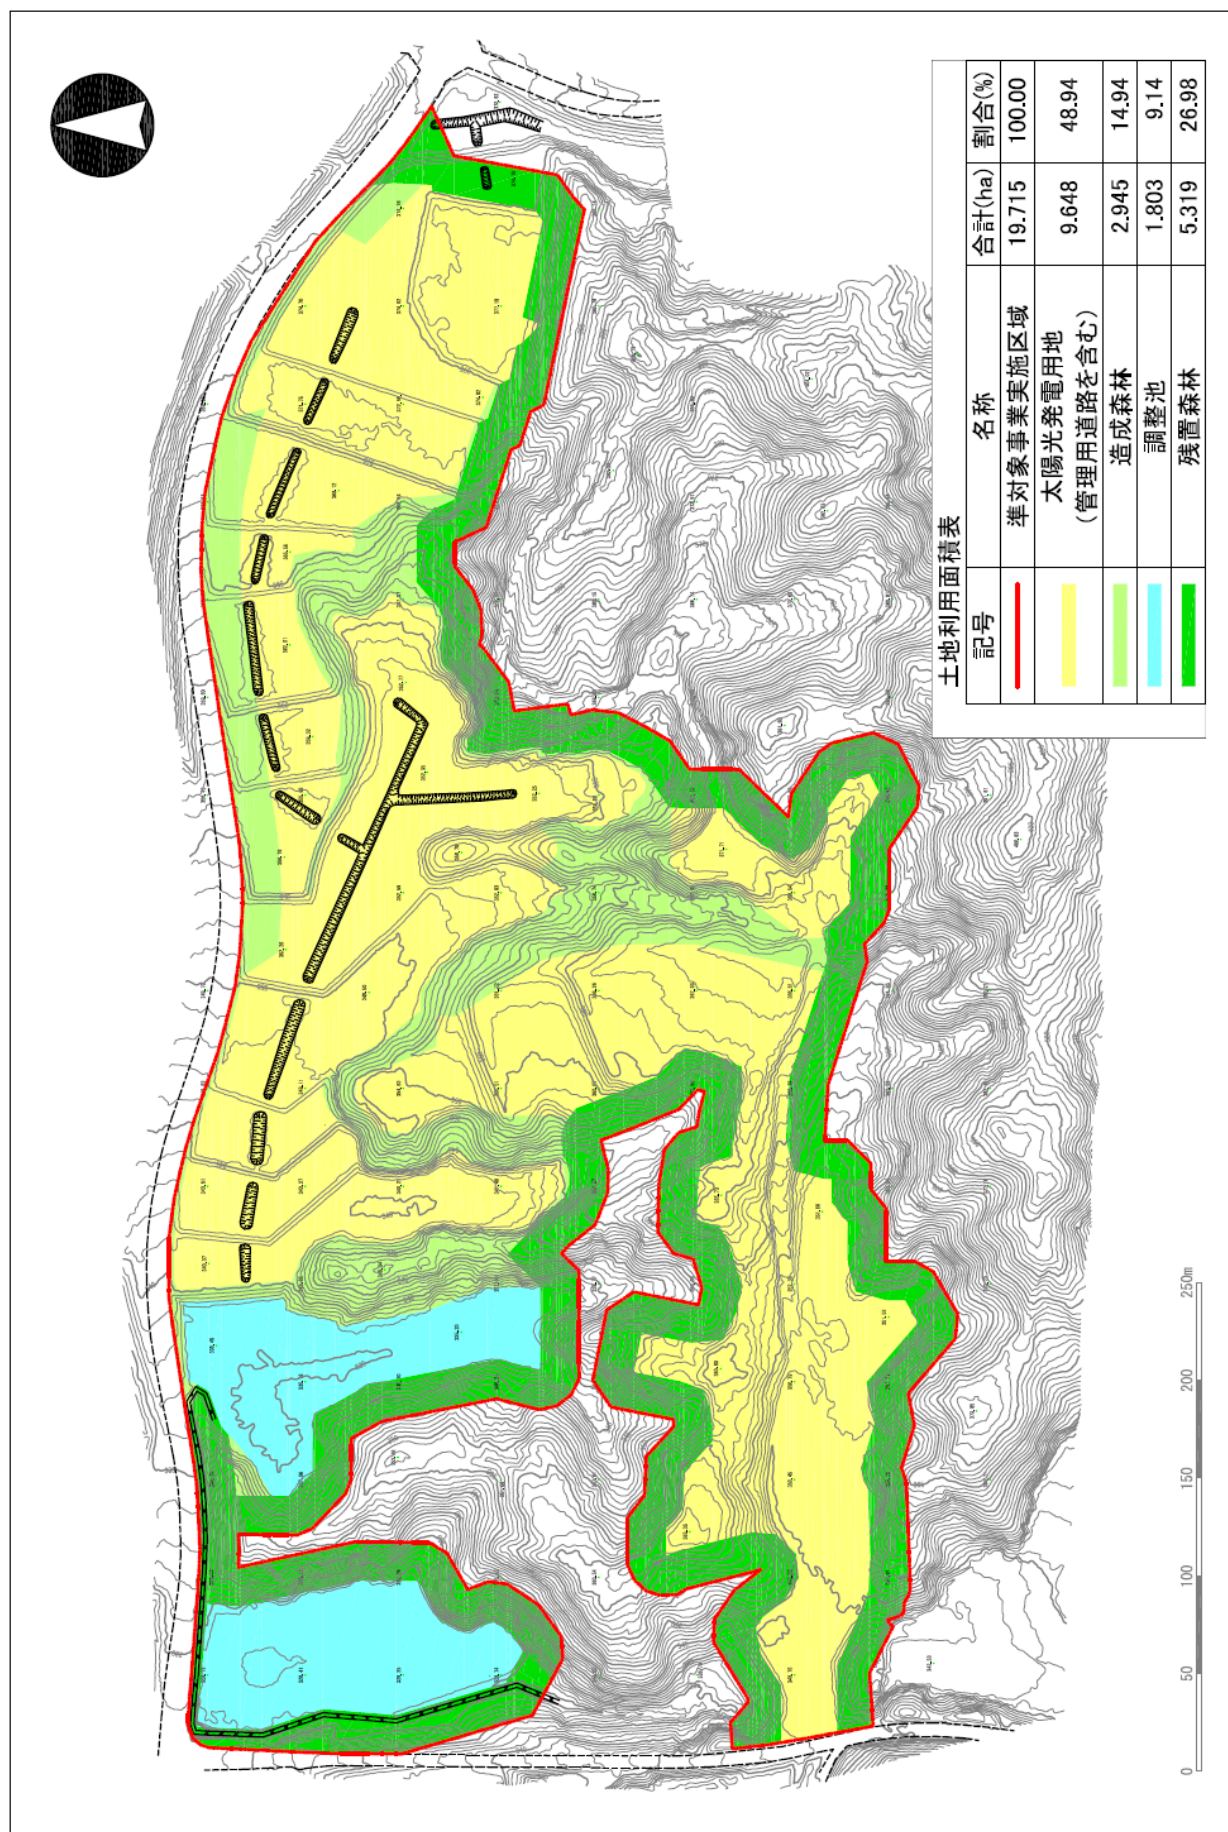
(2) 土地利用計画平面図（変更前計画）
